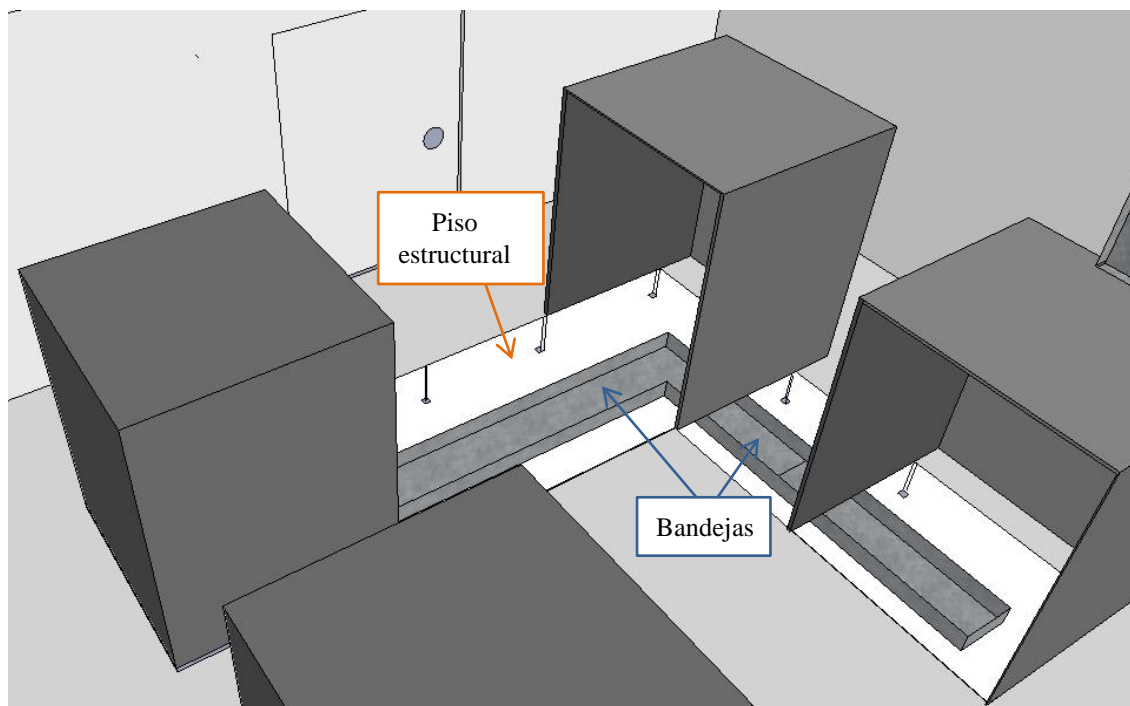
Enrutamiento horizontal con bandejas tipo ducto
